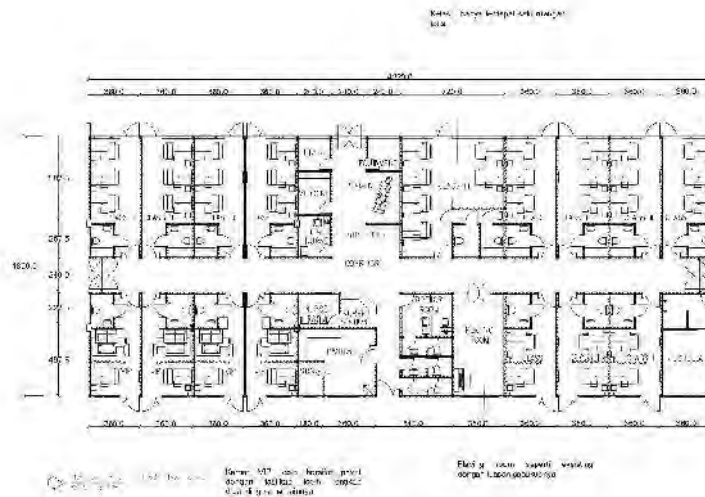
Denah Alternatif Layout Area Rawat Inap 1
